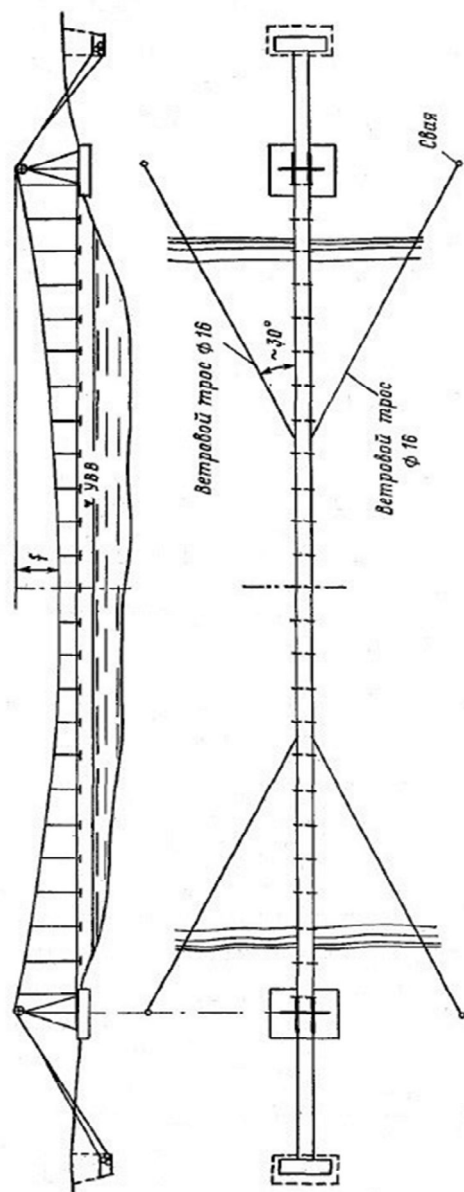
Продольный разрез и план подвесного гидрометрического мостика
